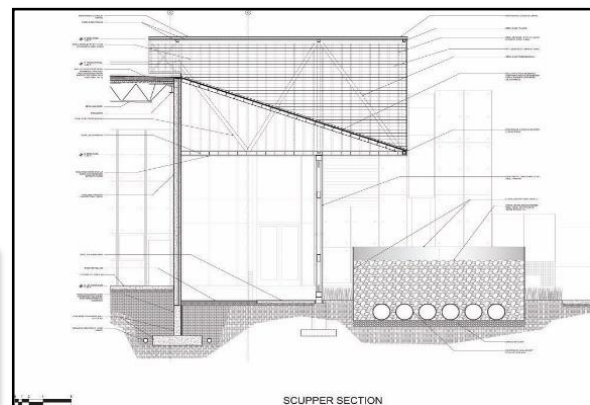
coupe transversale sur l'entrée principale de bâtiment GCS
